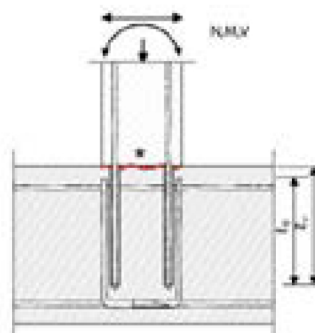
Ancoragem de lajes ou vigas dimensionadas como bi apoiadas.
